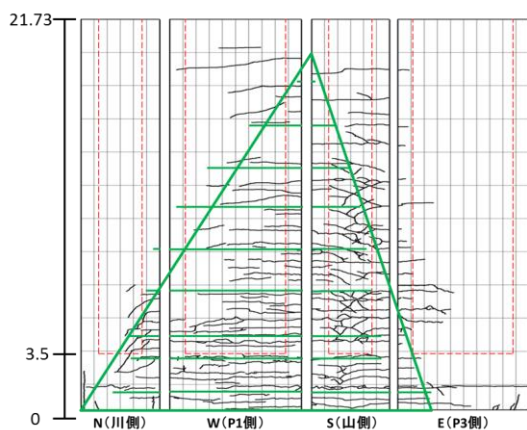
P2 橋脚ひび割れ再現図(1 方向)
